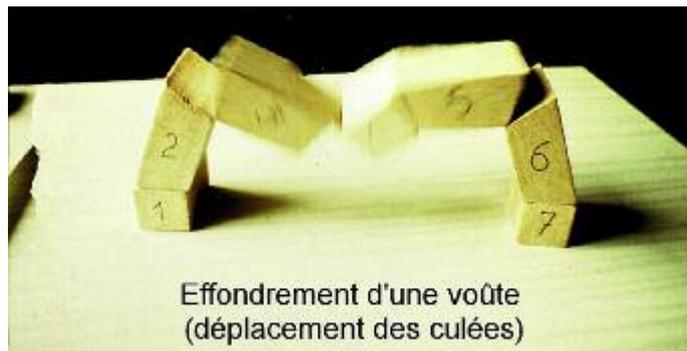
effondrement d'une maquette (crédit photo D. Poineau)
